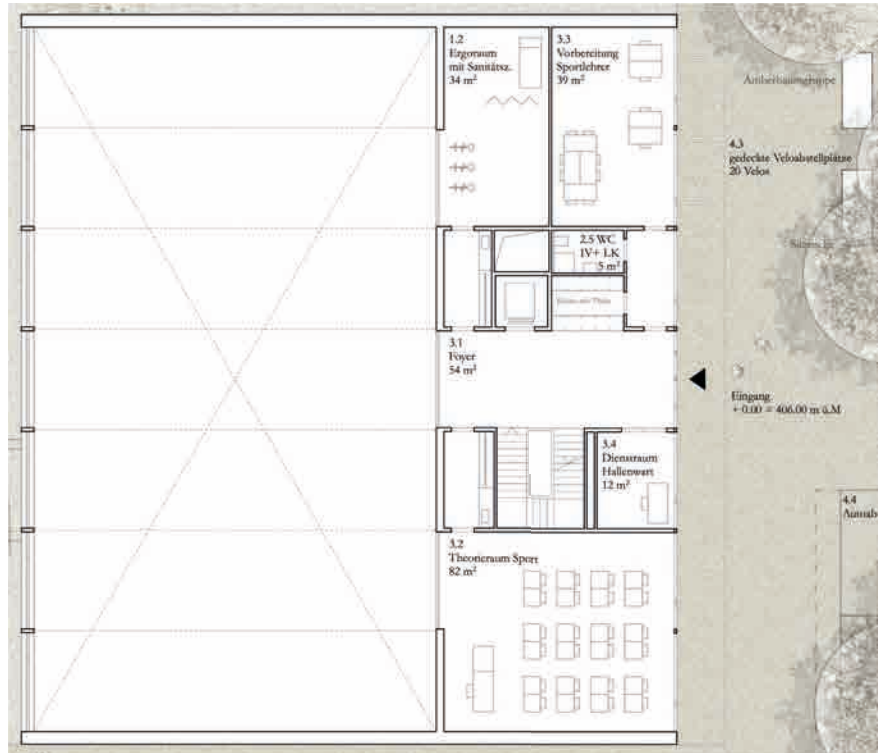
Grundriss Unter- / Obergeschoss
